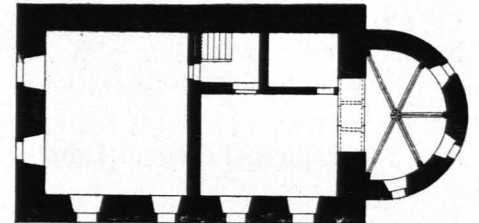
St. Pankrazkapelle bei Wurmbrand, Grundriß 1 : 300 (S. 296)
